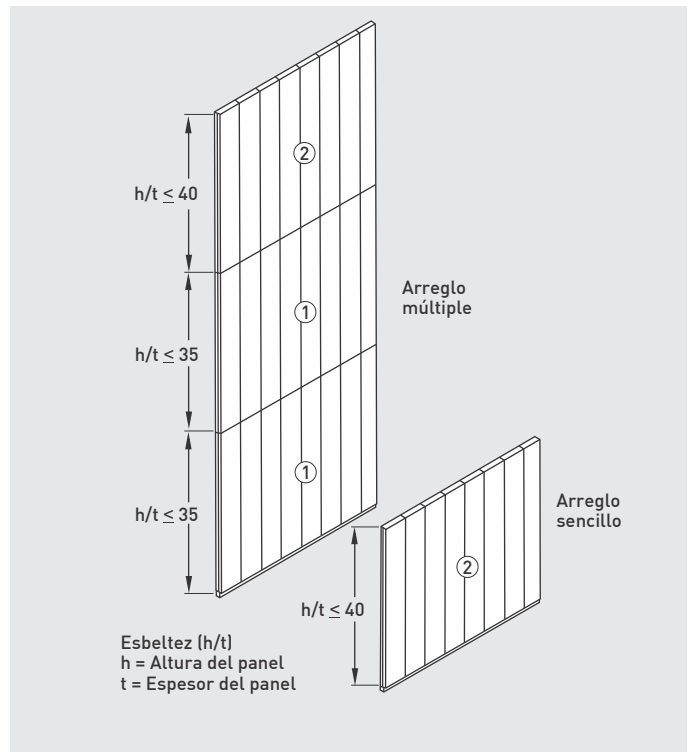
Arreglo vertical de paneles Hebel para muro.
